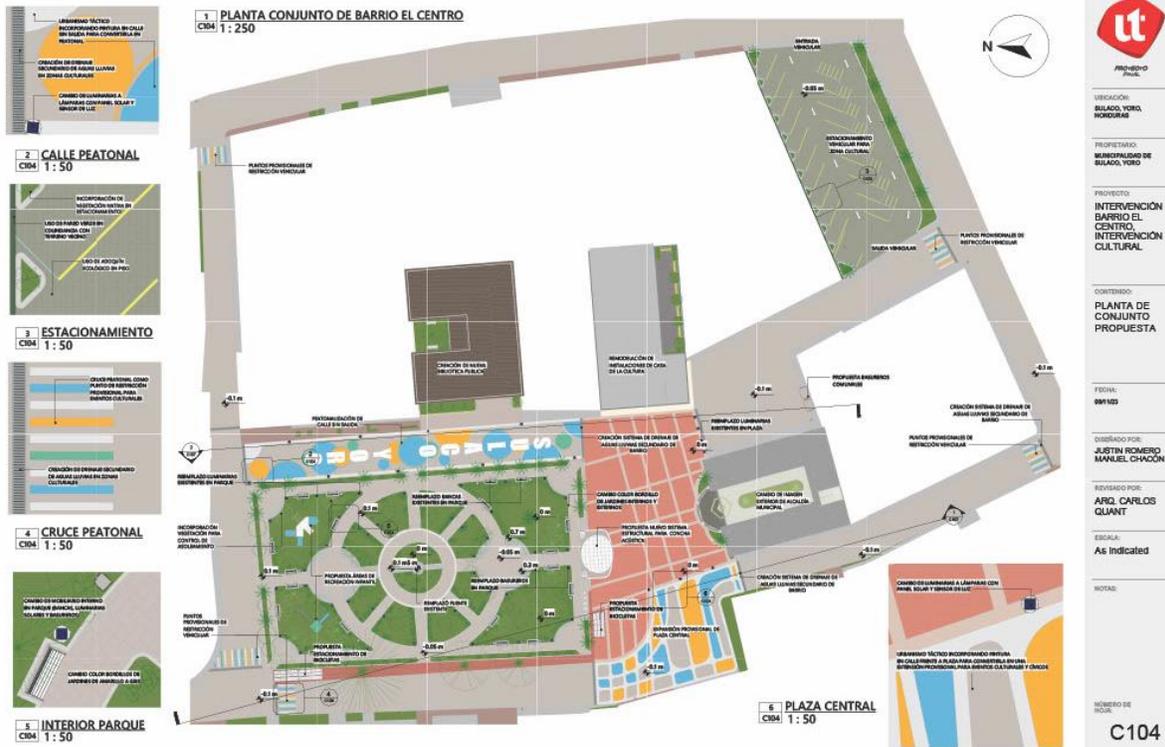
Plano de Conjunto | Fuente: elaboración Propia
